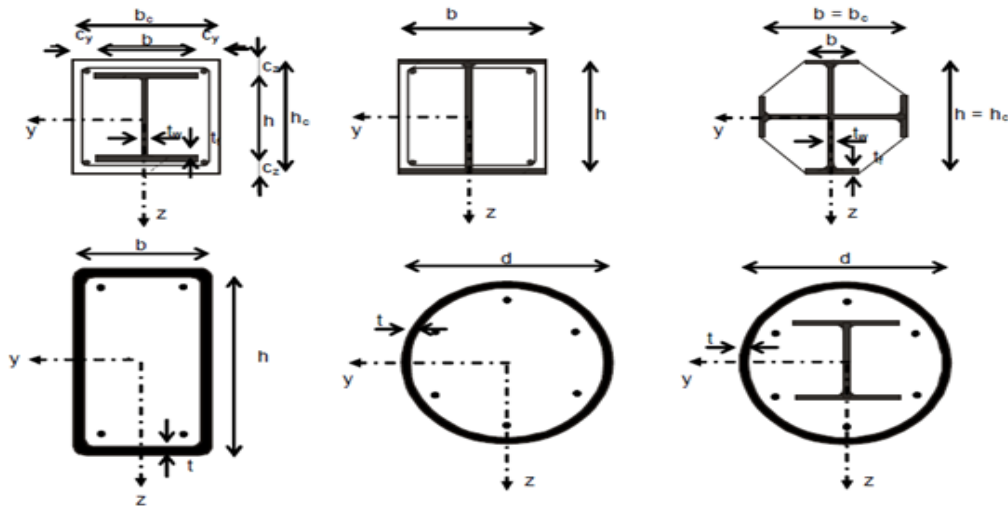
Exemples types de section transversale de poteaux. [62]
